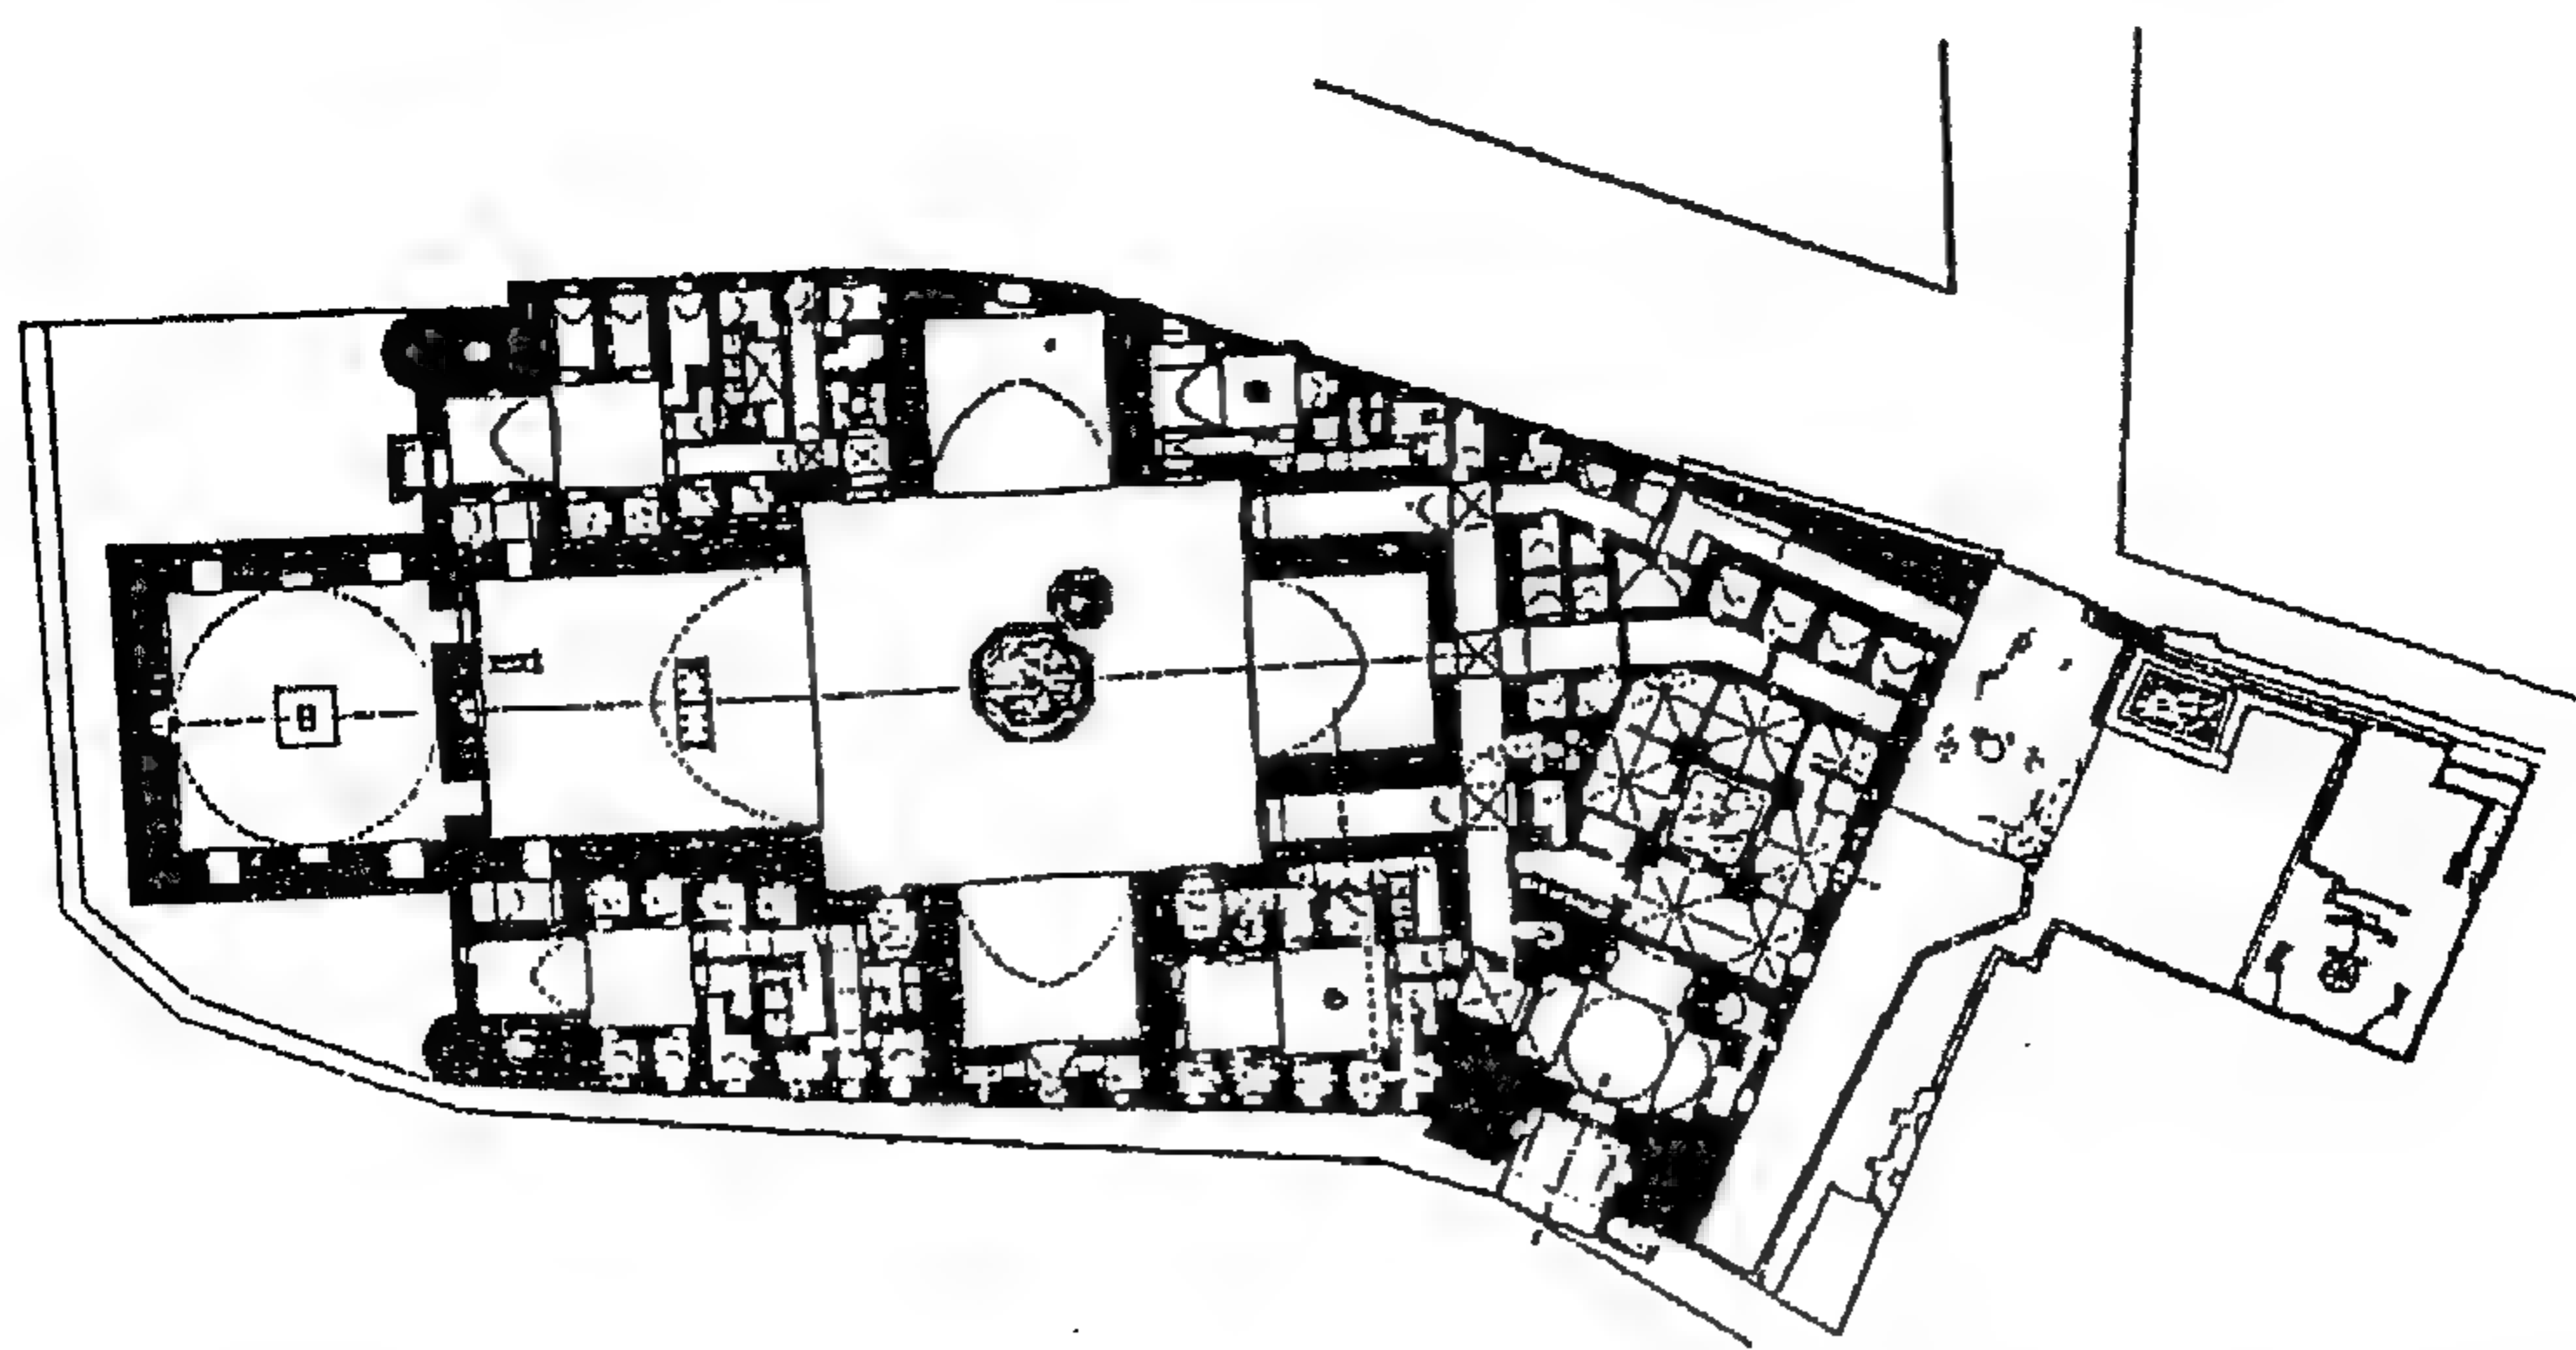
مسقط أفقي لمجمع السلطان قلاوون بالقاهرة . (عن : Creswell) .
